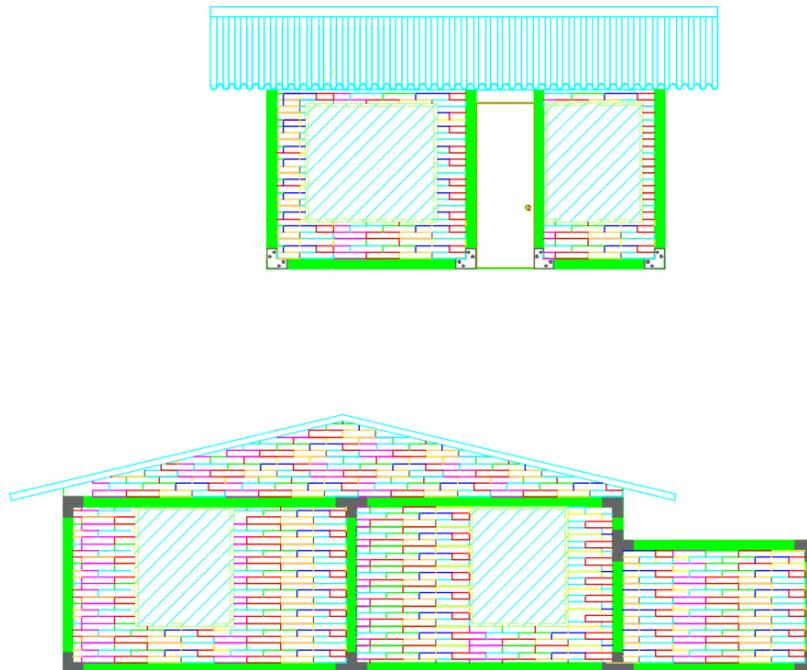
Detalle de Fachadas Fuente: Elaboración propia
